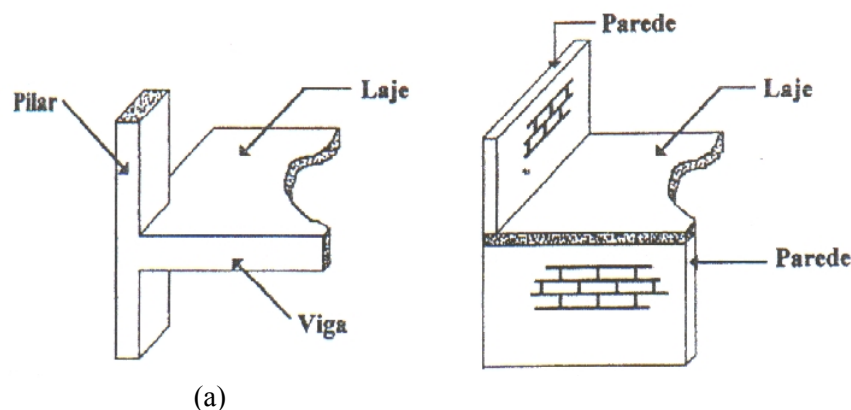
(a) estrutura linear (reticuladas) e (b) estrutura laminar
